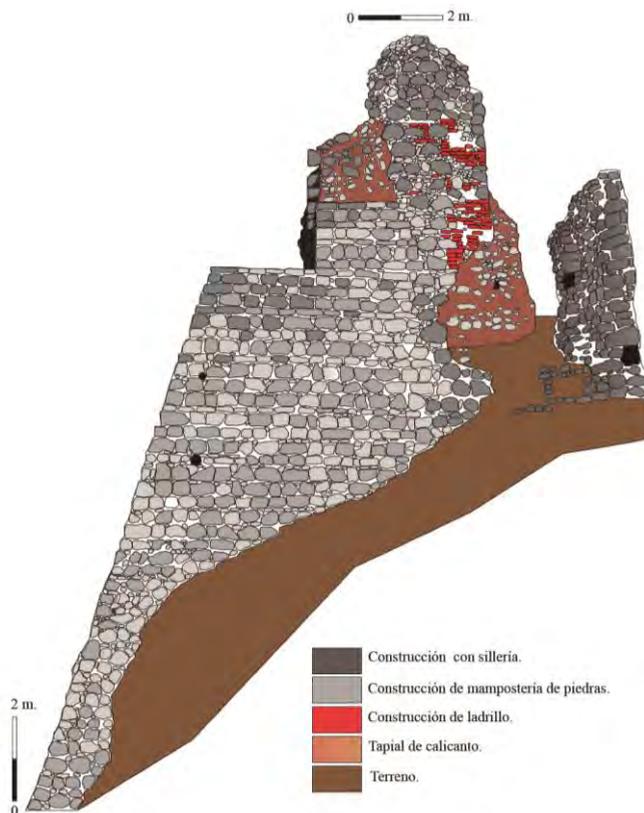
Alzado sureste exterior de la puerta de la fortaleza.
